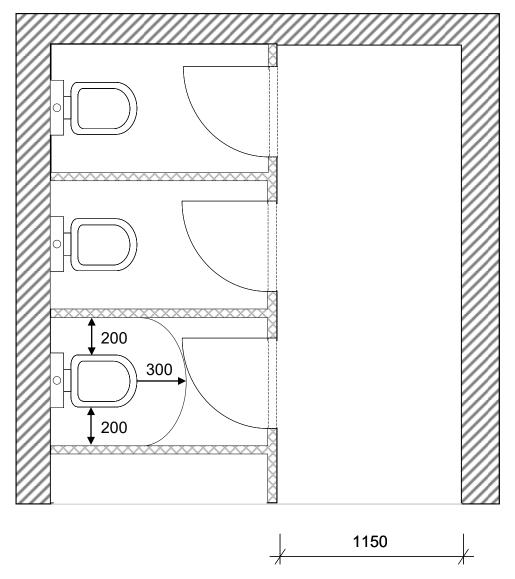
Einbündige Toilettenanlage, Türanschlag nach innen (Maße in mm)
